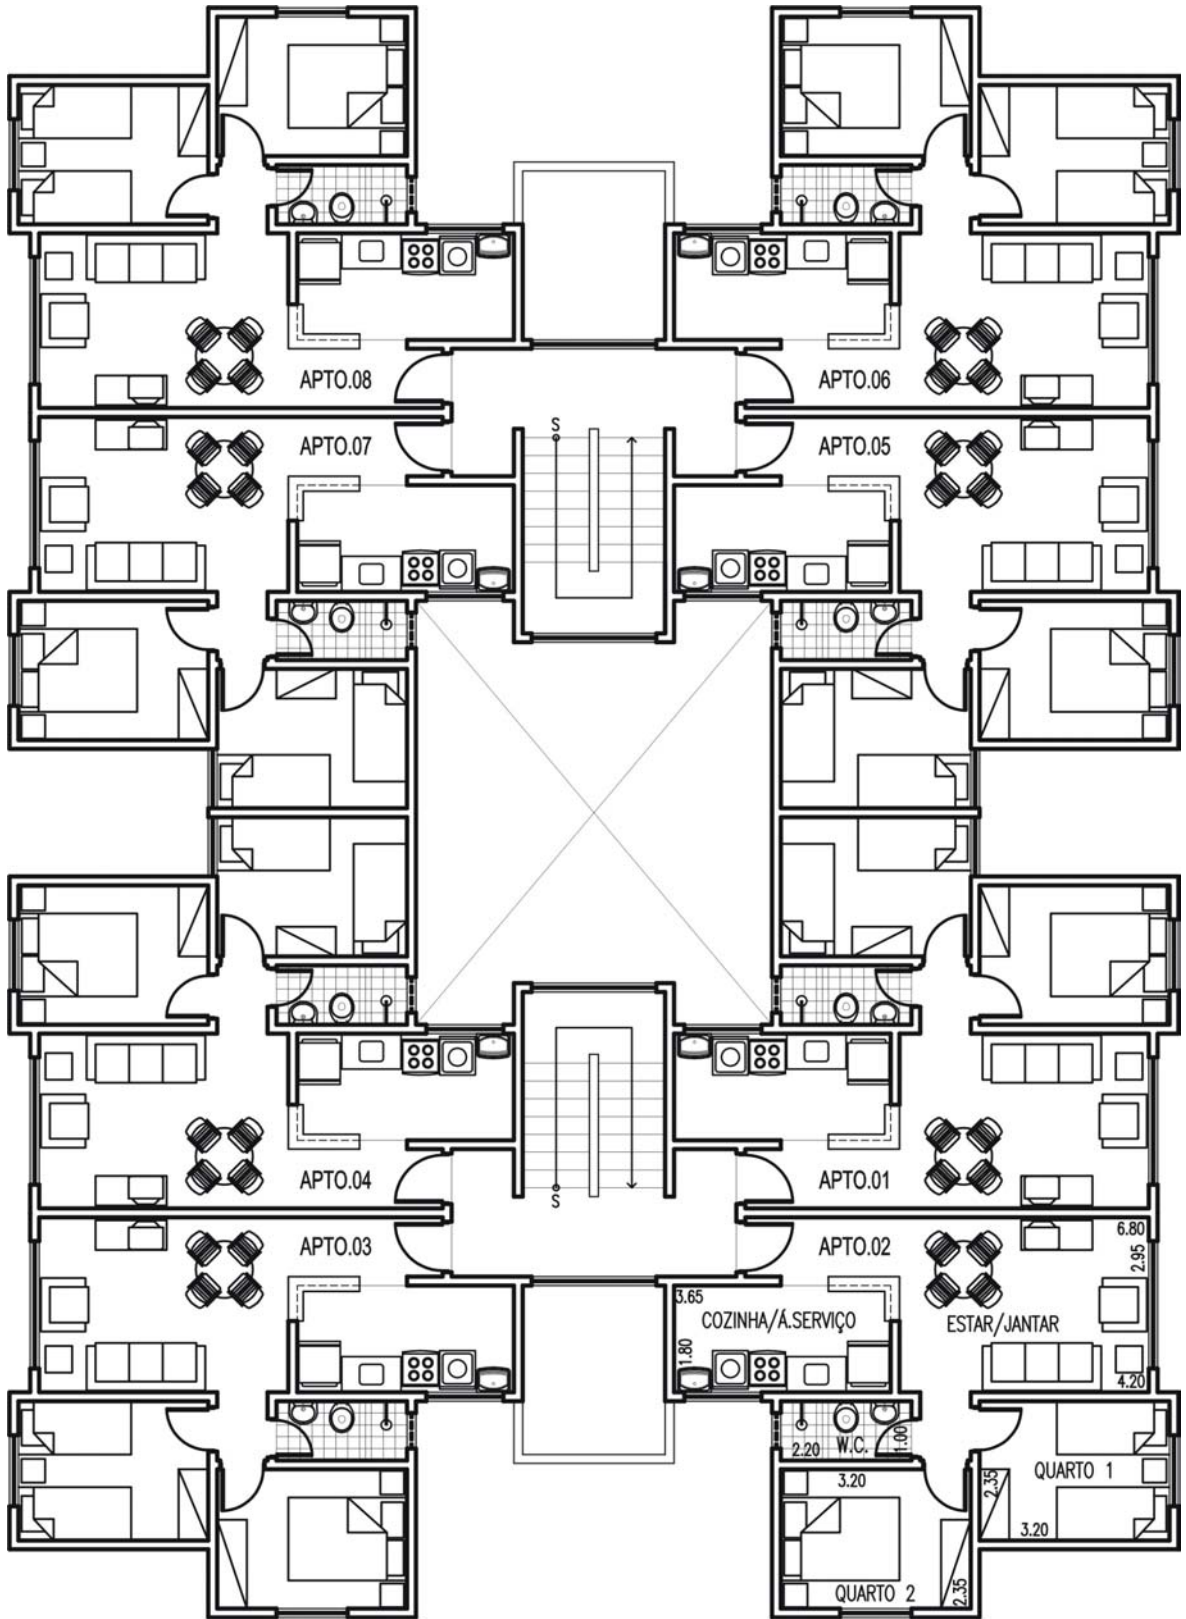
Planta baixa do pavimento tipo do Conjunto Morada das Orquídeas
